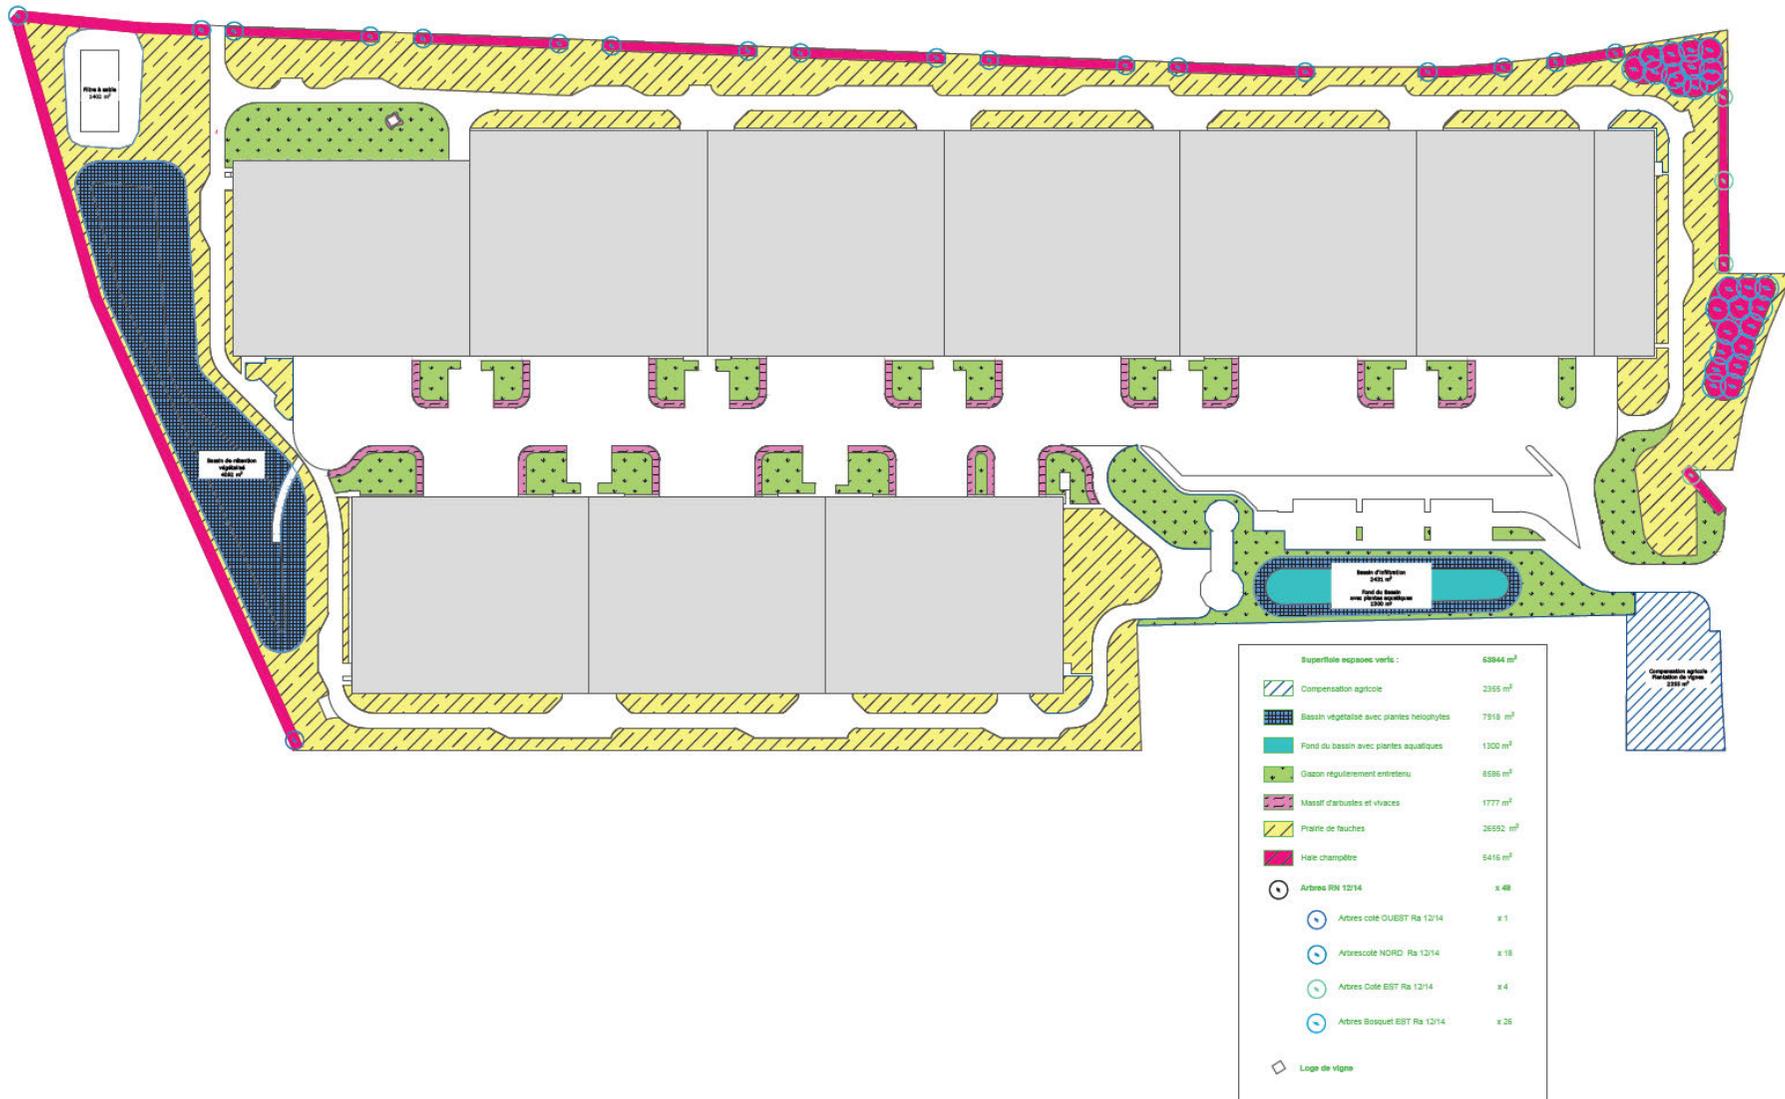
Plan des aménagements paysagers du projet (Source : Plantago)
